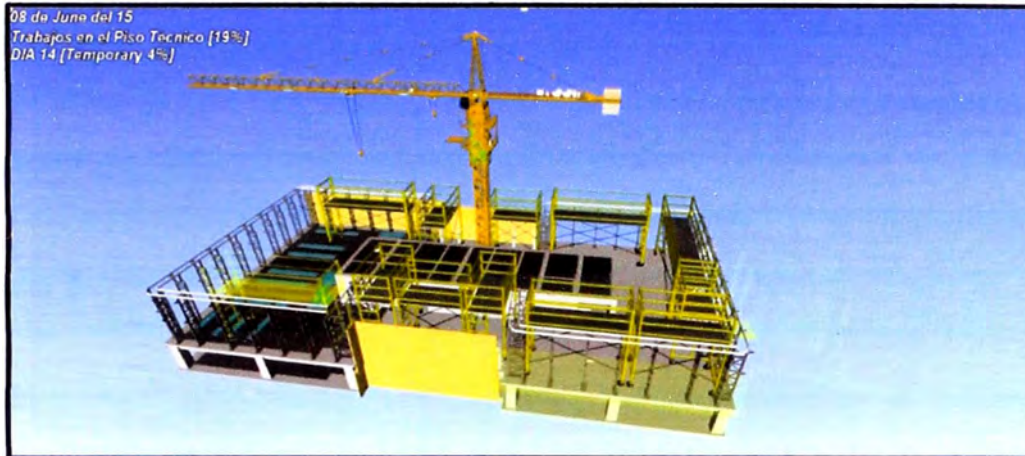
40: 4D de la Coronación del Edificio, Colocación de andamios para montaje de Estructura de muro cortina
